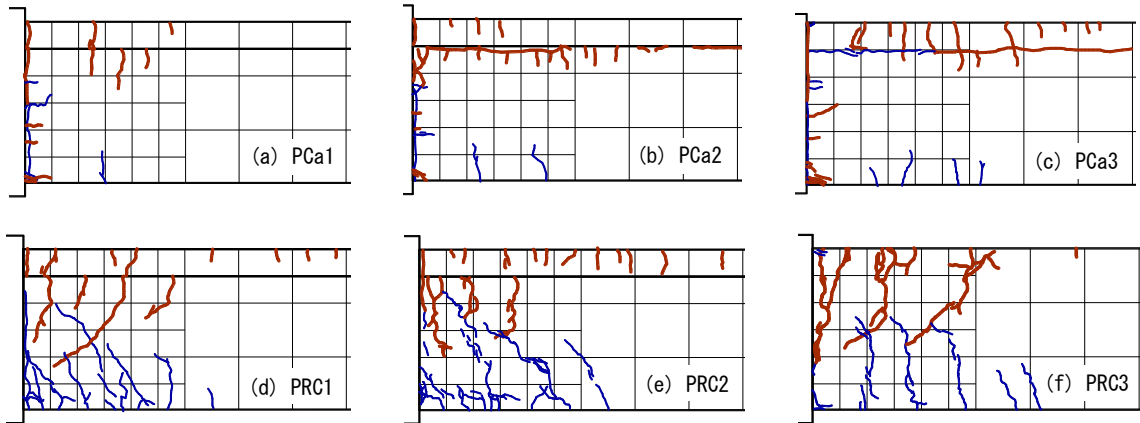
スラブと梁の側面におけるひび割れ状況 (部材変形角 1.0%)
